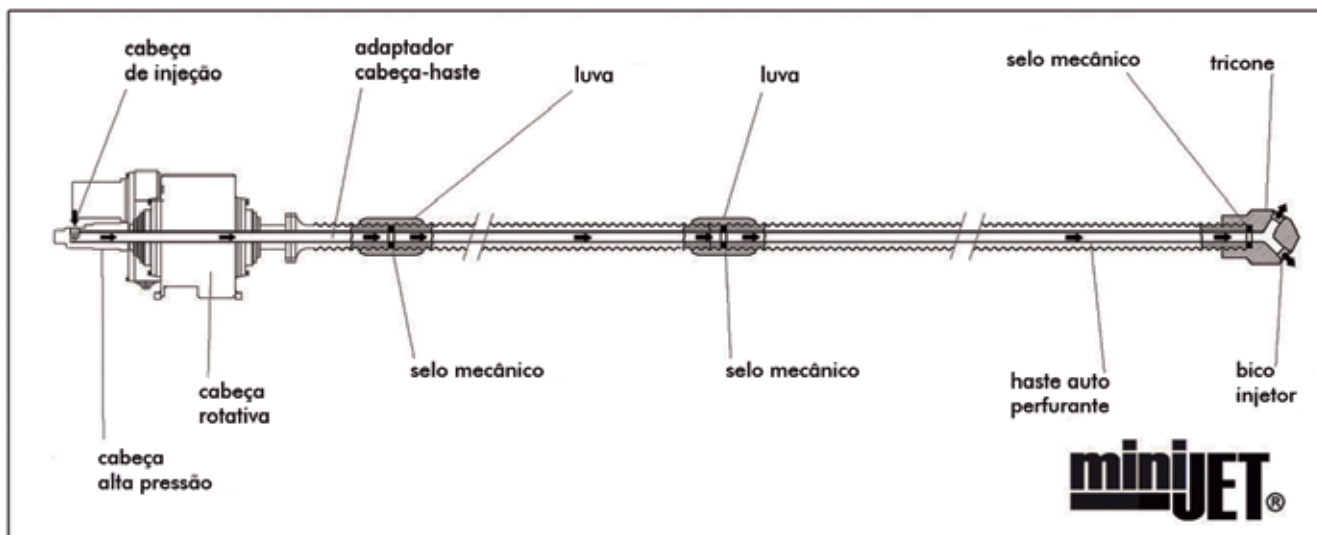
Sección longitudinal típica del montaje para la ejecución del jet grouting armado.
